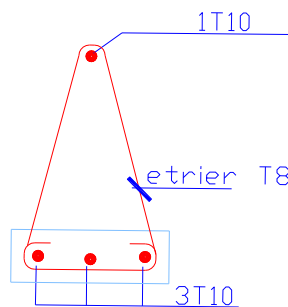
Plan de ferrailage de poutrelle (en travée)
